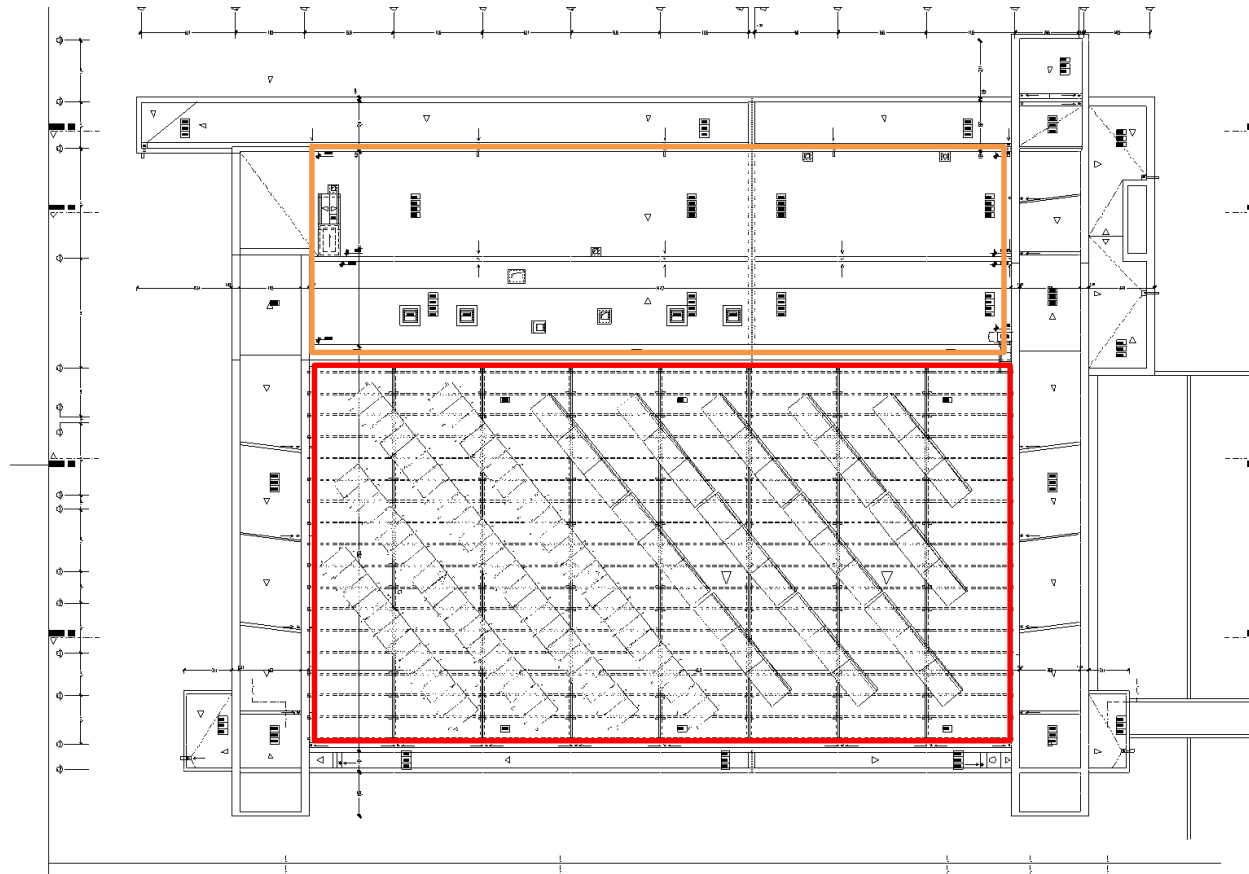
Planta cobertura - Fonte: Projeto de arquitetura
